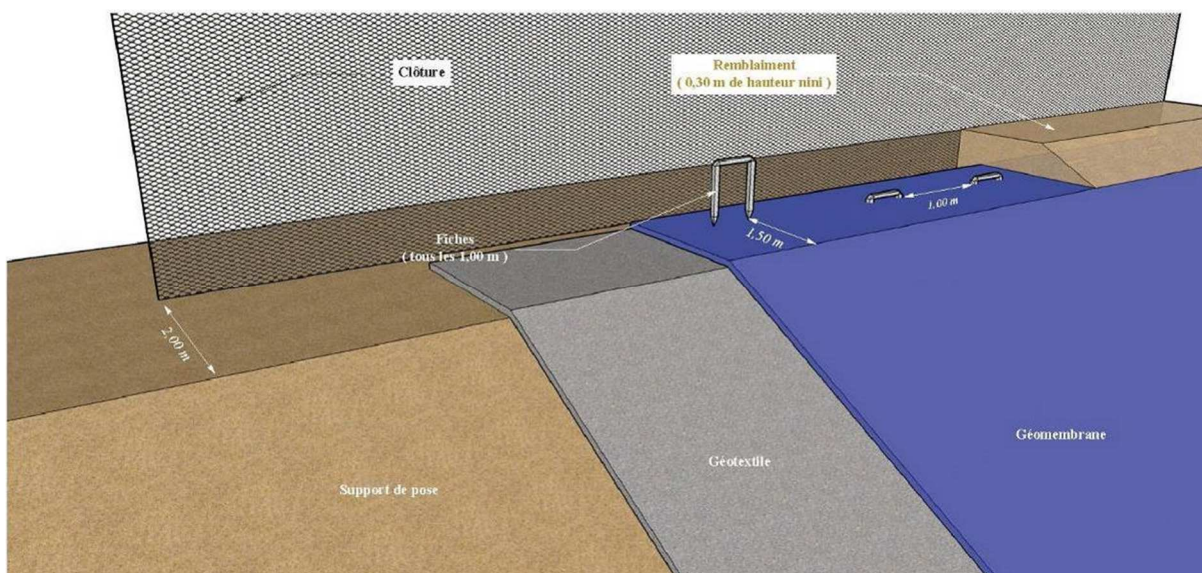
Exemple d'ancrage avec section pesante en remblai
